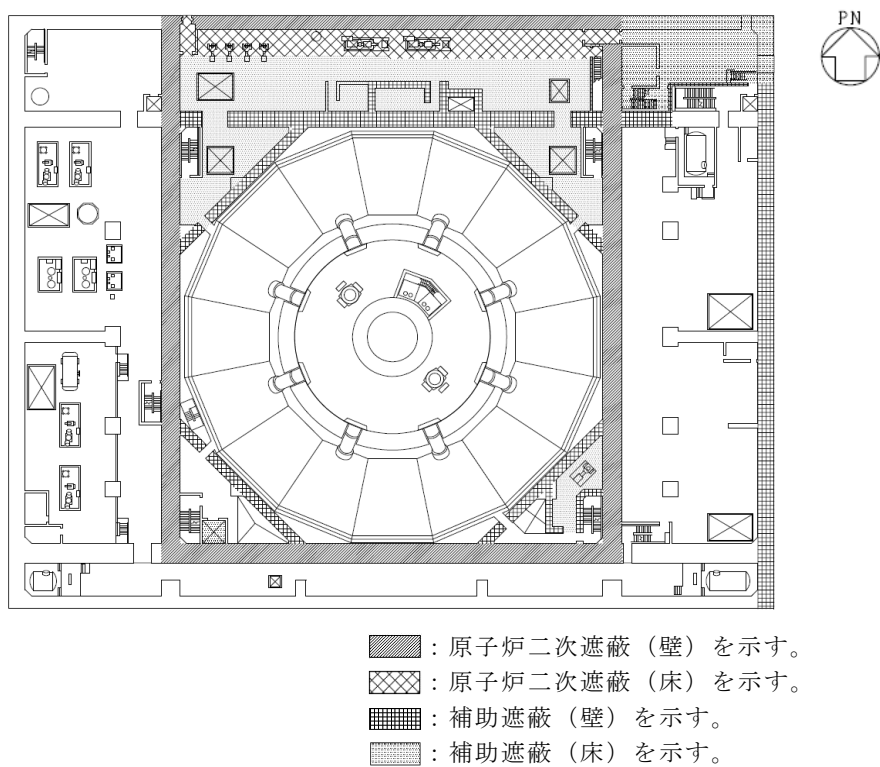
(2) 原子炉二次遮蔽及び補助遮蔽（原子炉建物）の範囲の平面図
